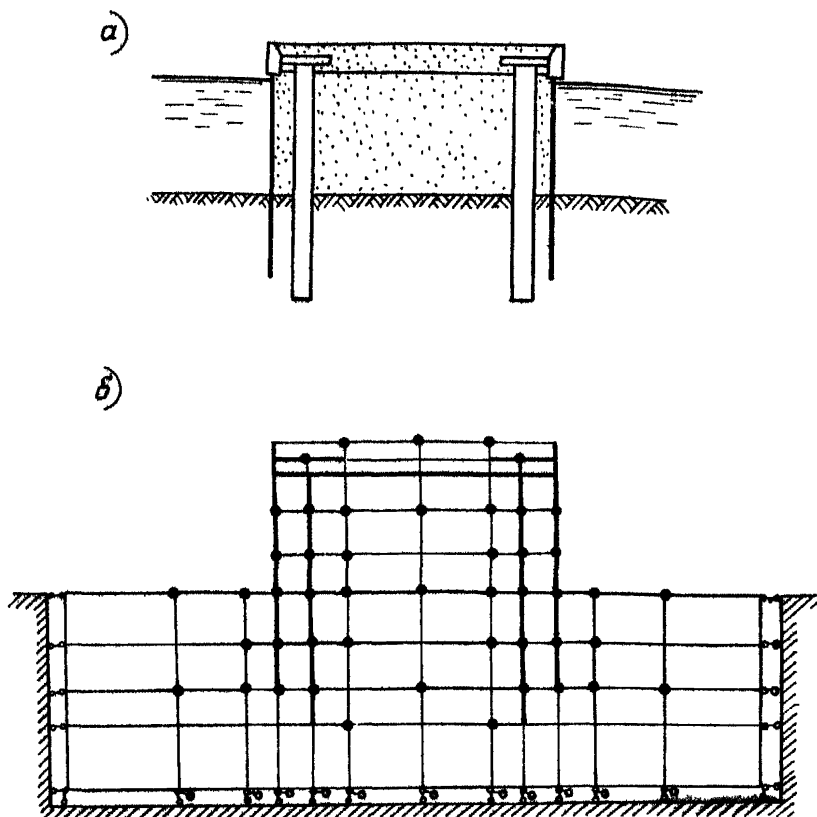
Расчетная схема засыпного пиера в виде взаимозащкренных больверков а – разрез пиера, б – расчетная схема по МКЭ
